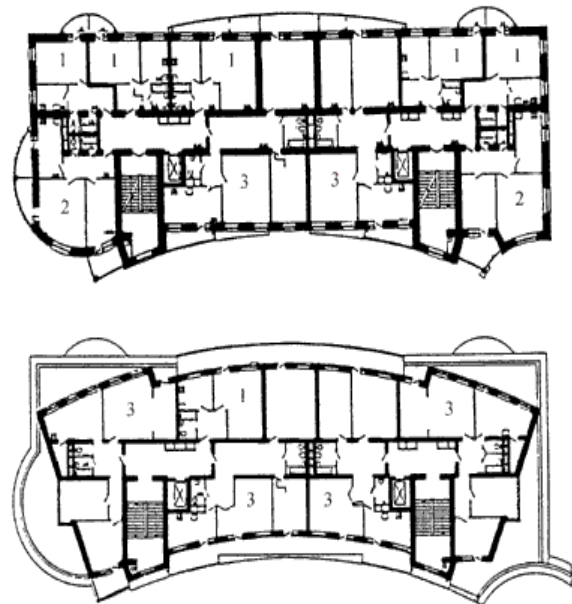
Общий вид и планы типового и надстроенного этажей здания по Владимирской улице в г. Москве после реконструкции
